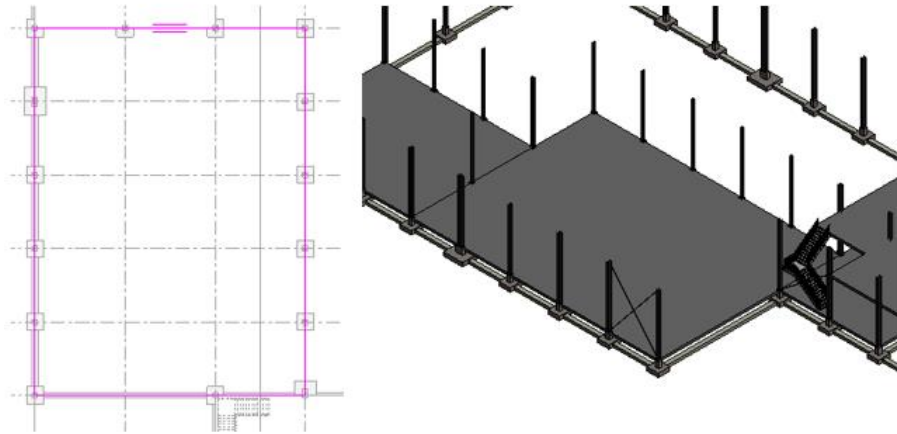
Resultado para el suelo en la zona almacén. Vista planta y en 3D.
